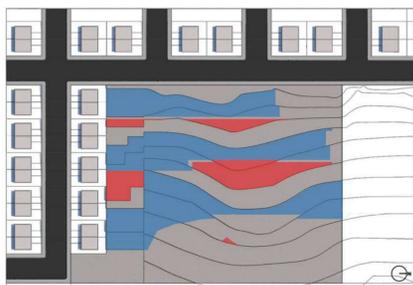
Movimentação de terra (Vermelho/corte e Azul/aterro)
